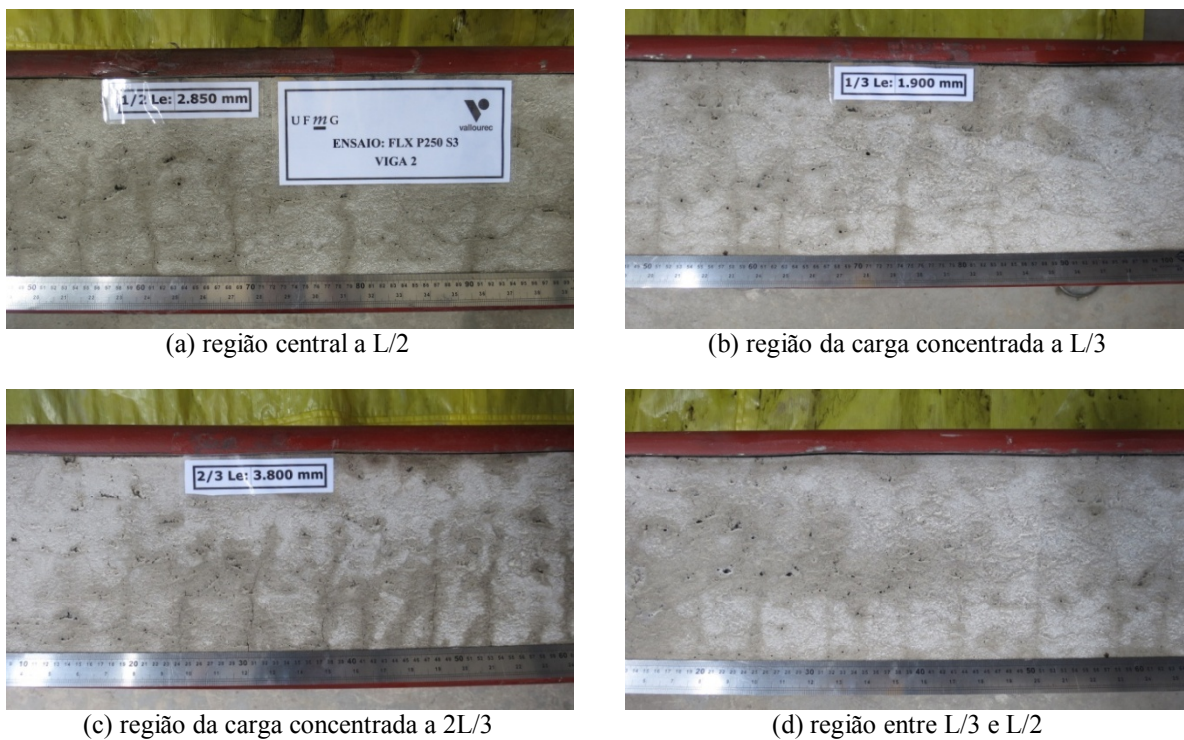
Ensaio de flexão: fissuração do núcleo do protótipo FLX-VM-SL-TB-2
